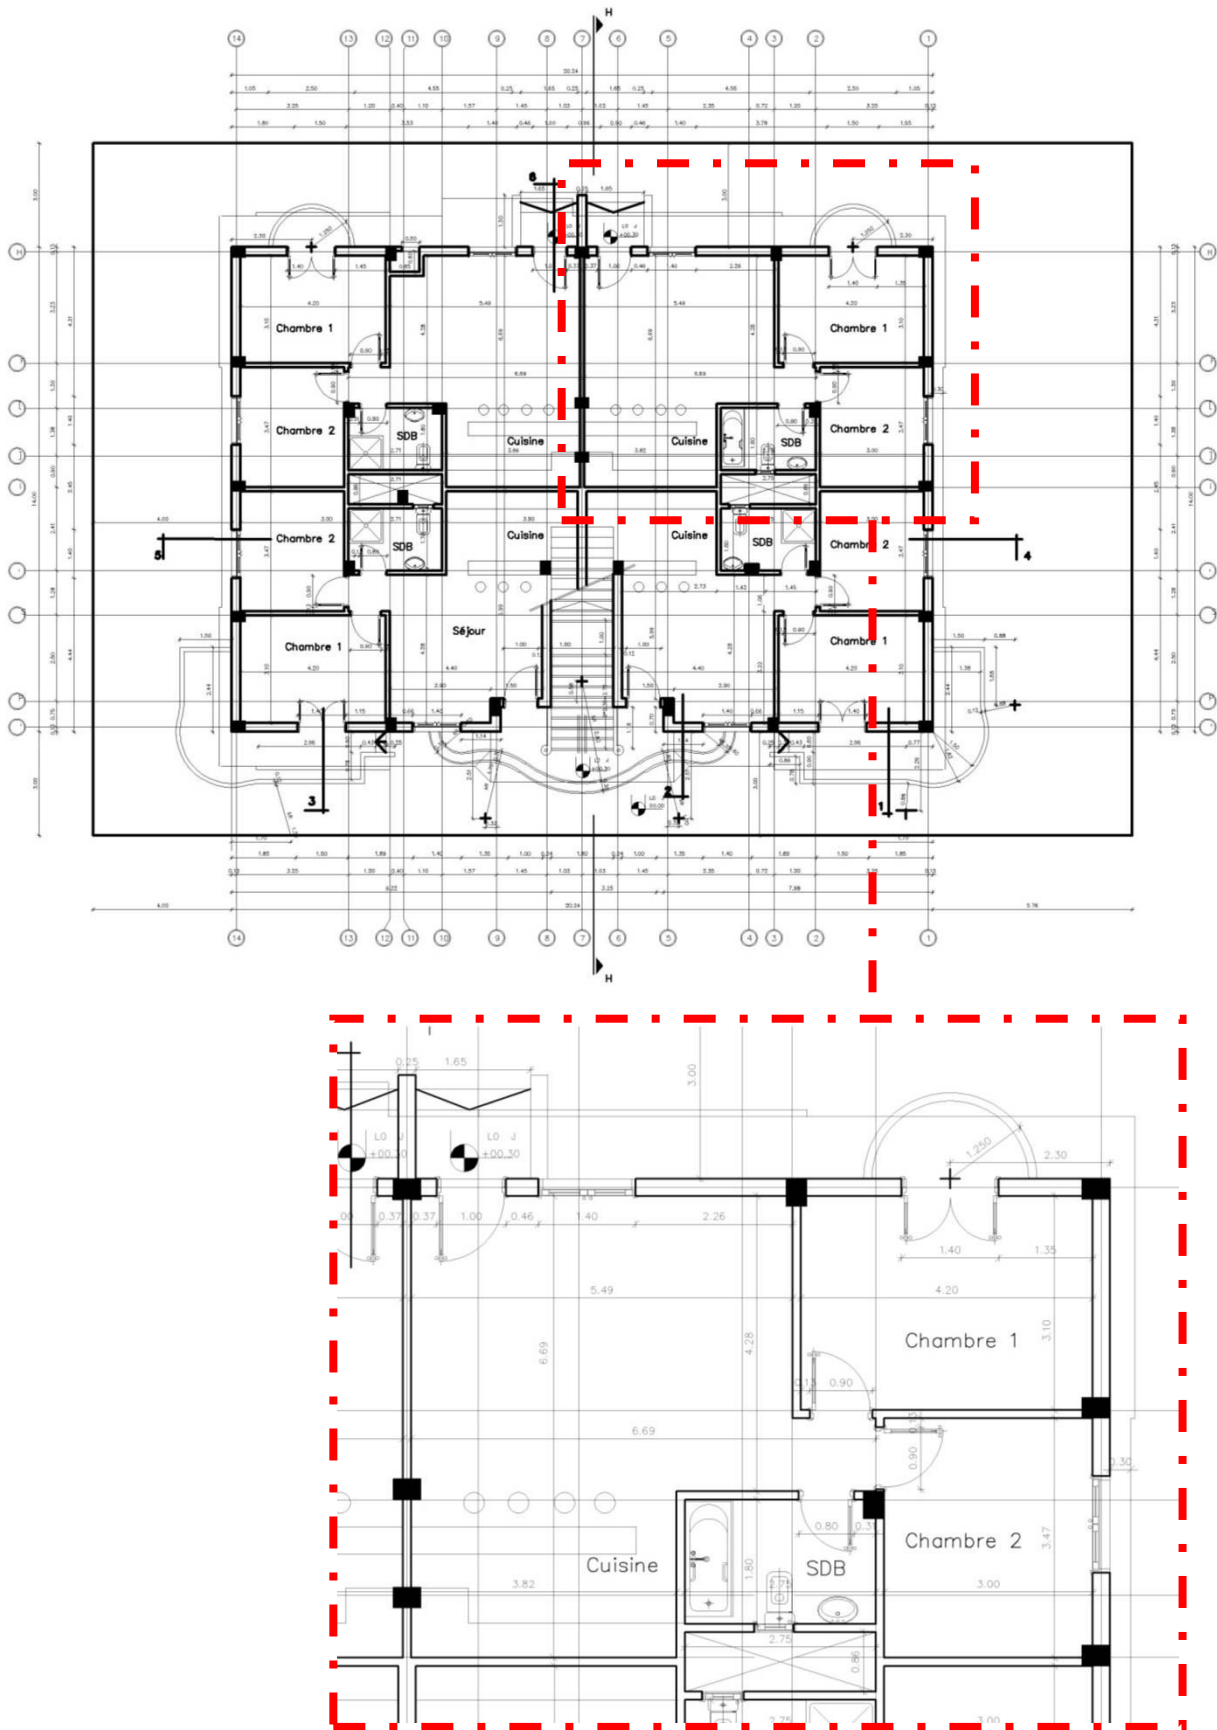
Plan RDC, exemple d'un bâtiment en béton armée et murs en briques à Charm El-Cheikh, Sinai.
